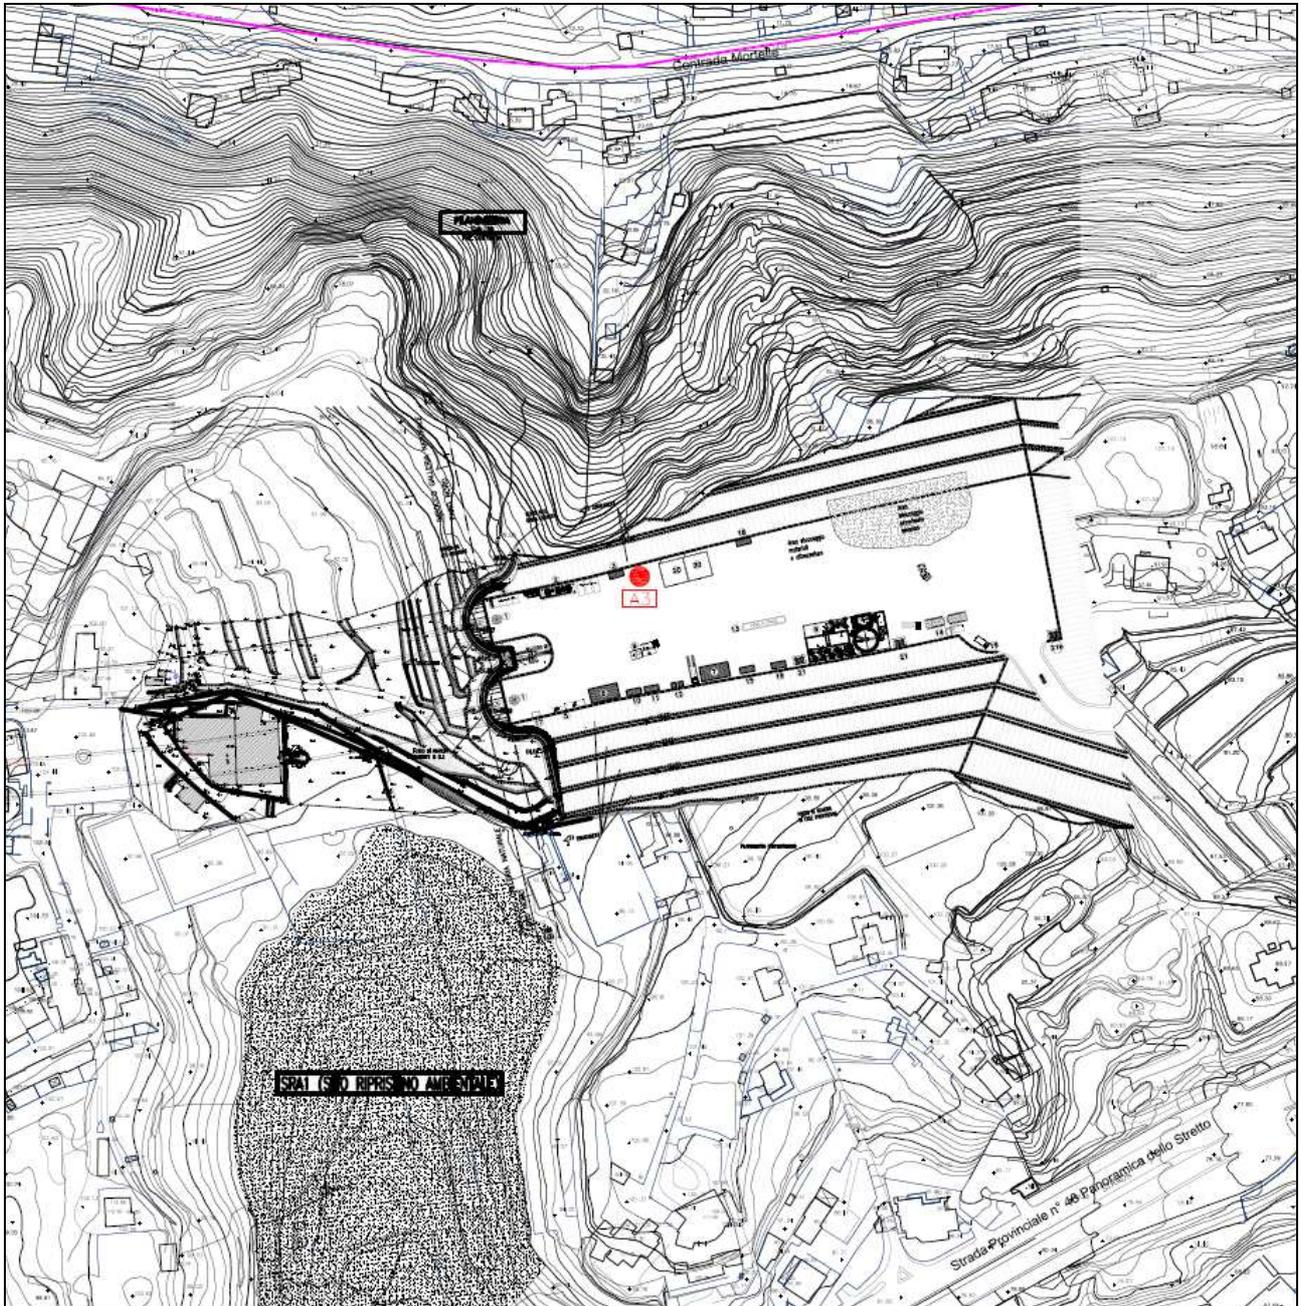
Cantiere SI2 Faro Superiore – Localizzazione punti allacciamento
